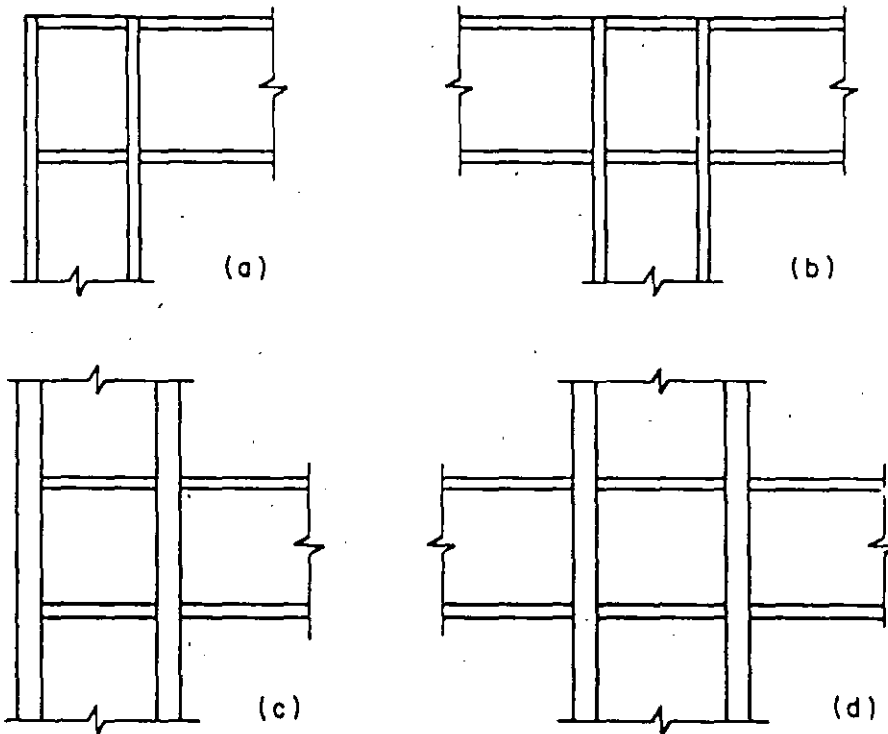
Conexiones viga-columna de marcos rígidos
